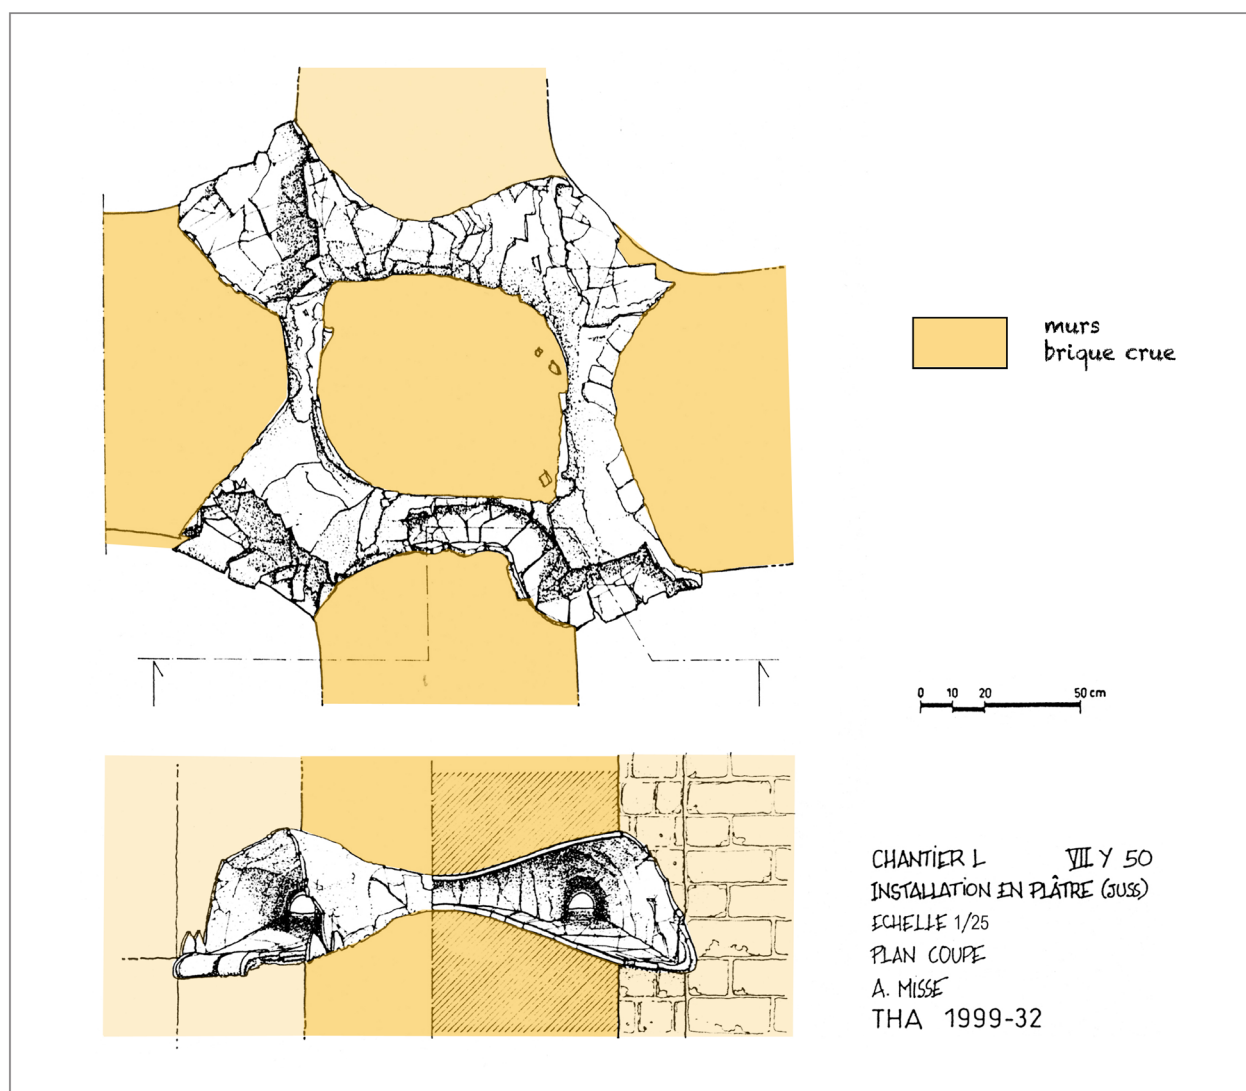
plan et coupe de l'installation dégagée en 1999.
